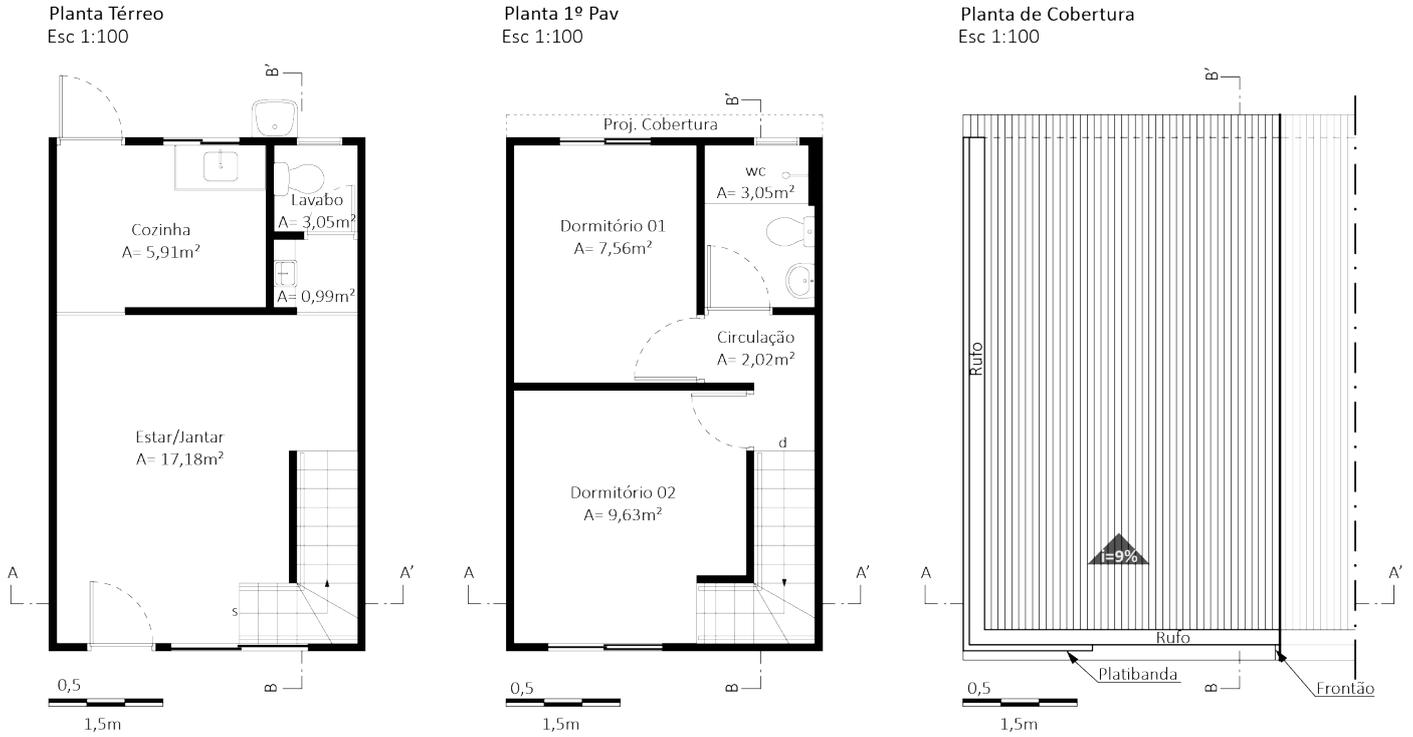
Plantas do térreo, pavimento superior e cobertura da unidade unifamiliar: dois dormitórios
